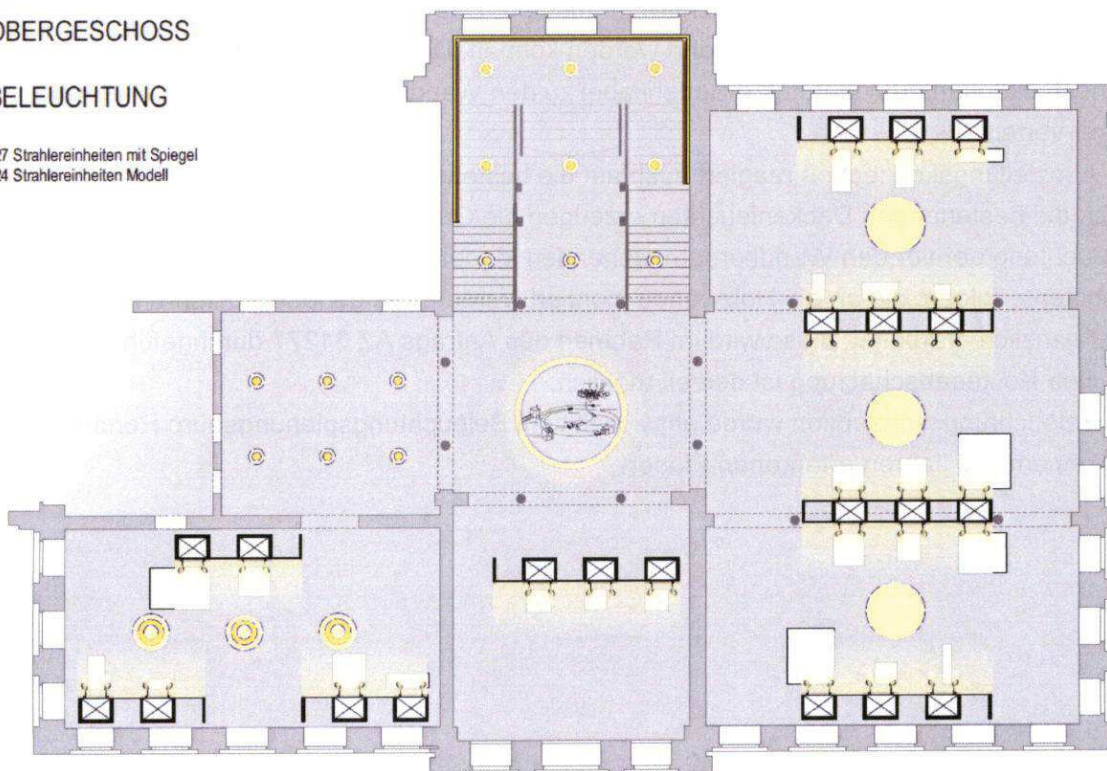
Beleuchtungskonzept Grundrissdarstellung
